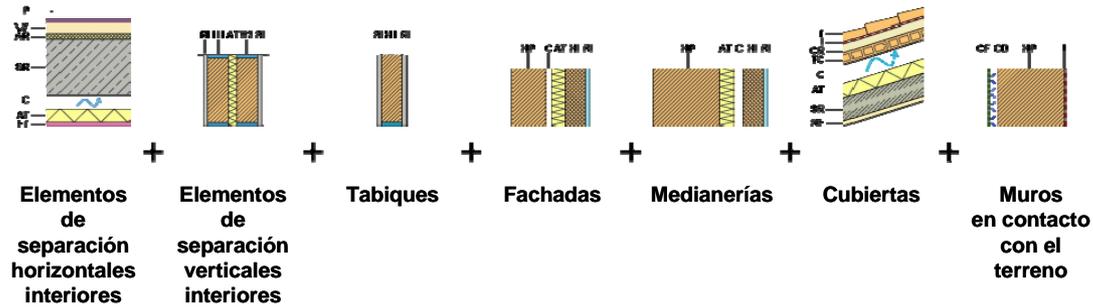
Elementos constructivos considerados en los cálculos predictivos
